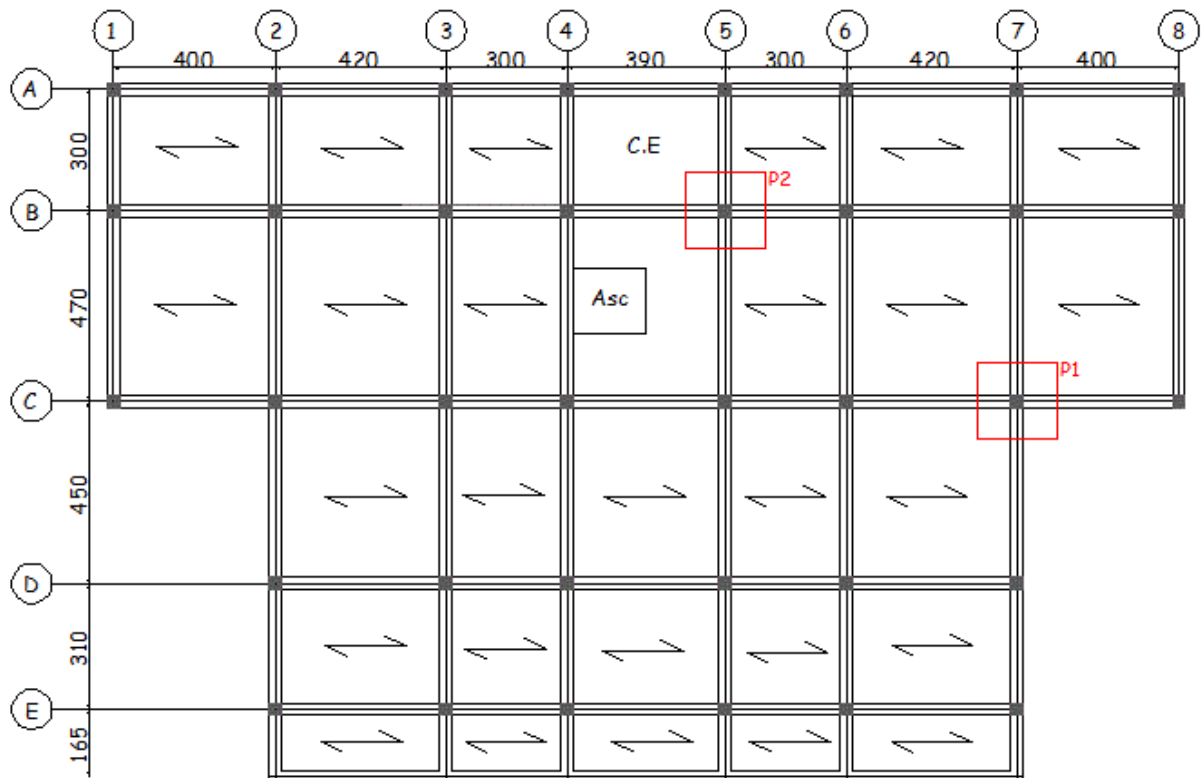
Schémas de la disposition des poutrelles dans étage courant.
